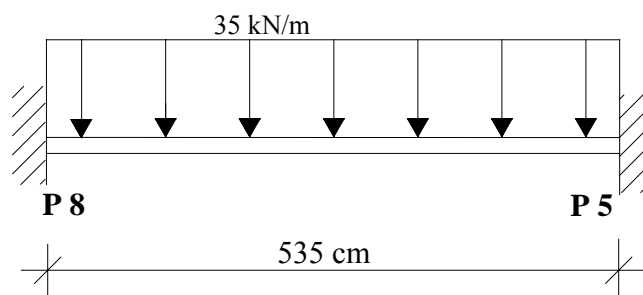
Esquema estático e carregamento no vão da viga adjacente ao pilar.
